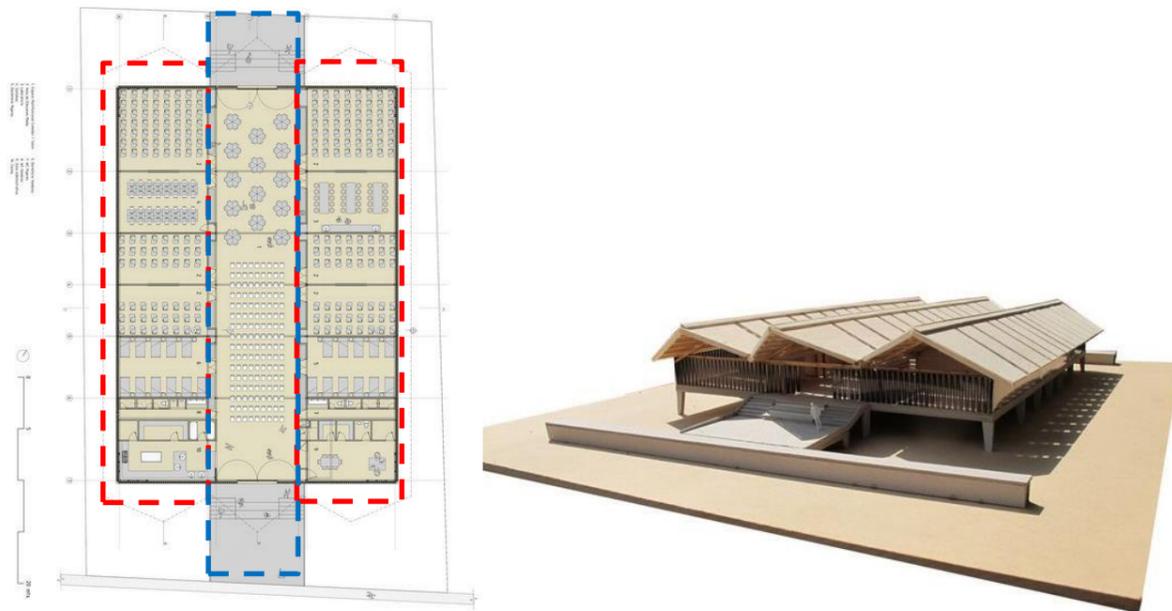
Planta y perspectiva 3D de la Institución Educativa Embera Atrato Medio, diseñado por Plan B Arquitectos. Fuente: www.plataformaarquitectura.cl
